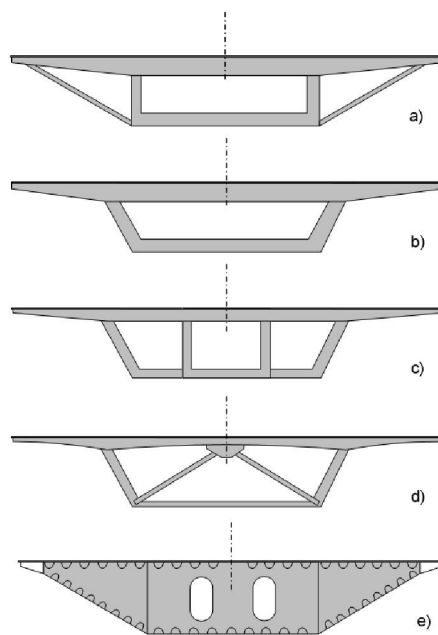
Configurações-tipo da secção transversal do tabuleiro com suspensão central (Pedro, J.J.O., 2010).
